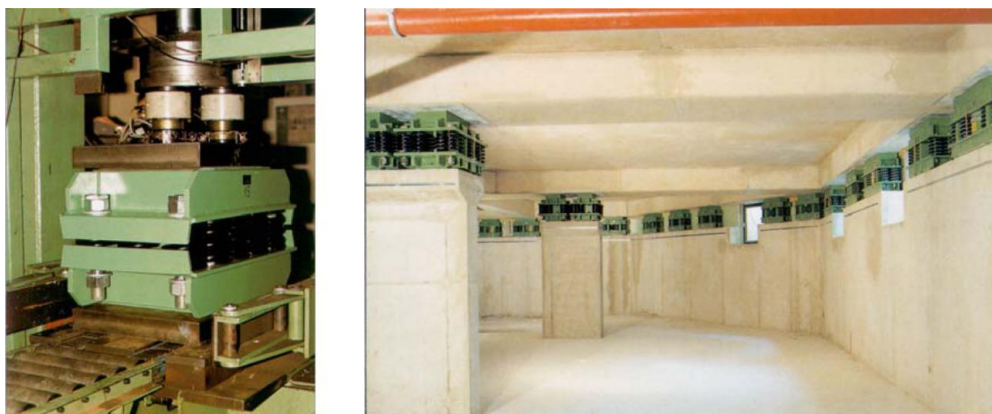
Sistema de aislamiento de base para vibraciones GERB e instalación en la Planta baja del hospital “Sant Pau” de Barcelona, realizado por Luis Bozzo.
